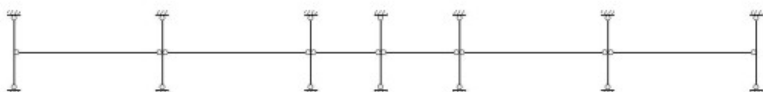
Расчетная схема плоской рамы с шарнирным соединением ригелей.
